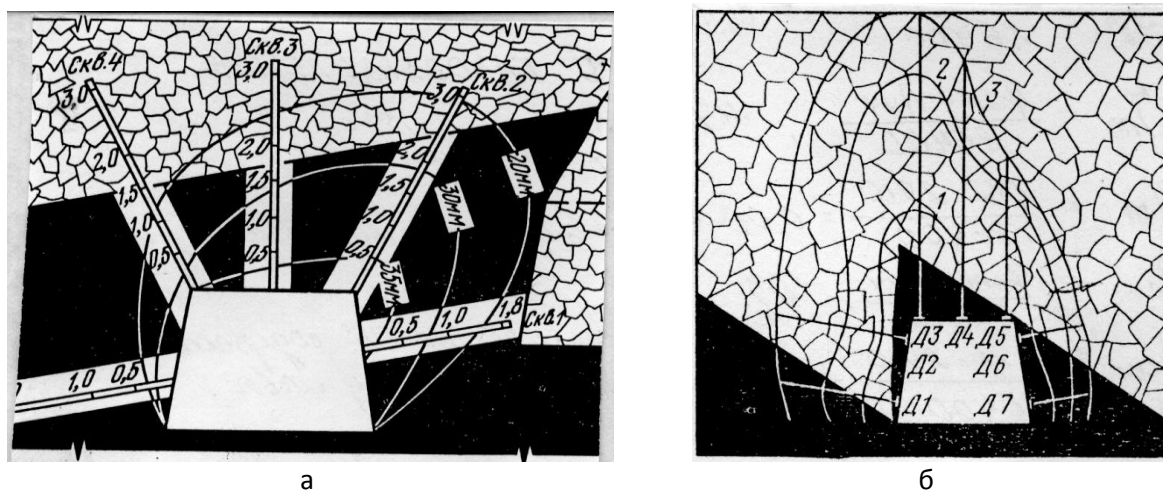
Смещения пород в вентиляционном штреке лавы 25 (а) и распределение нагрузки на крепь в вентиляционном штреке лавы 14 (б)
